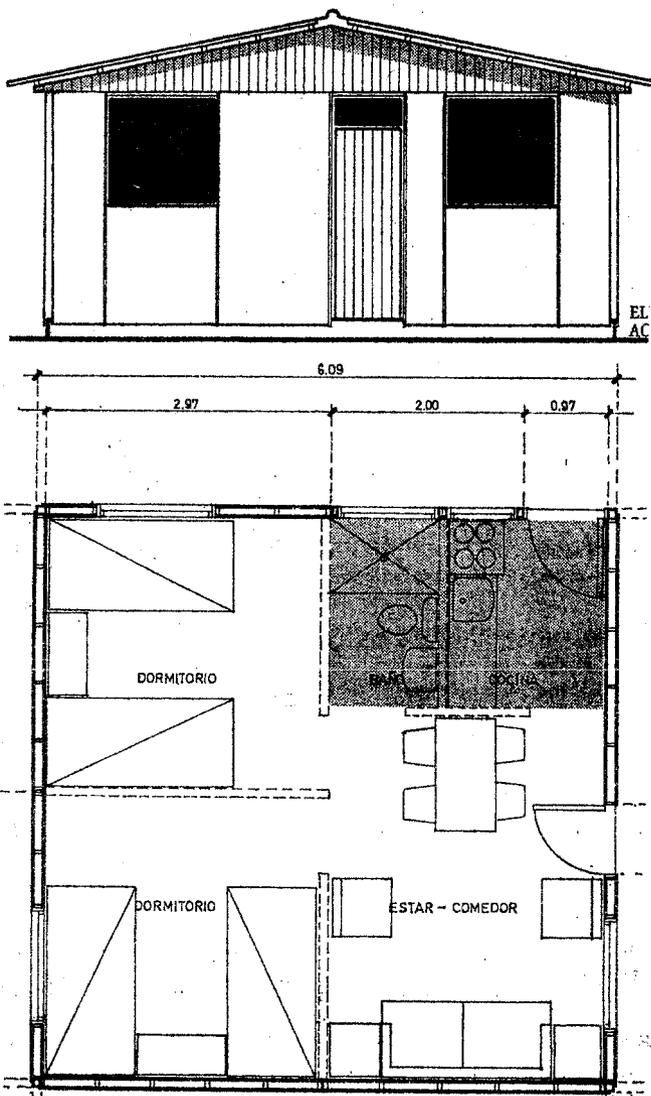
Planta elevación de un tipo de vivienda de asbesto-cemento del Programa 20.000/70.
